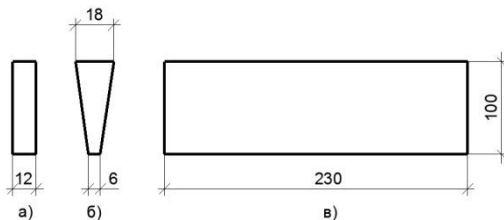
Конструкция однощелевого фундамента серии испытаний №1: а – прямоугольного сечения, б – конусного сечения, в – главный вид
